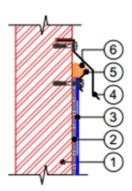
Примыкание кровли к стене с механическим креплением края кровельного ковра:
